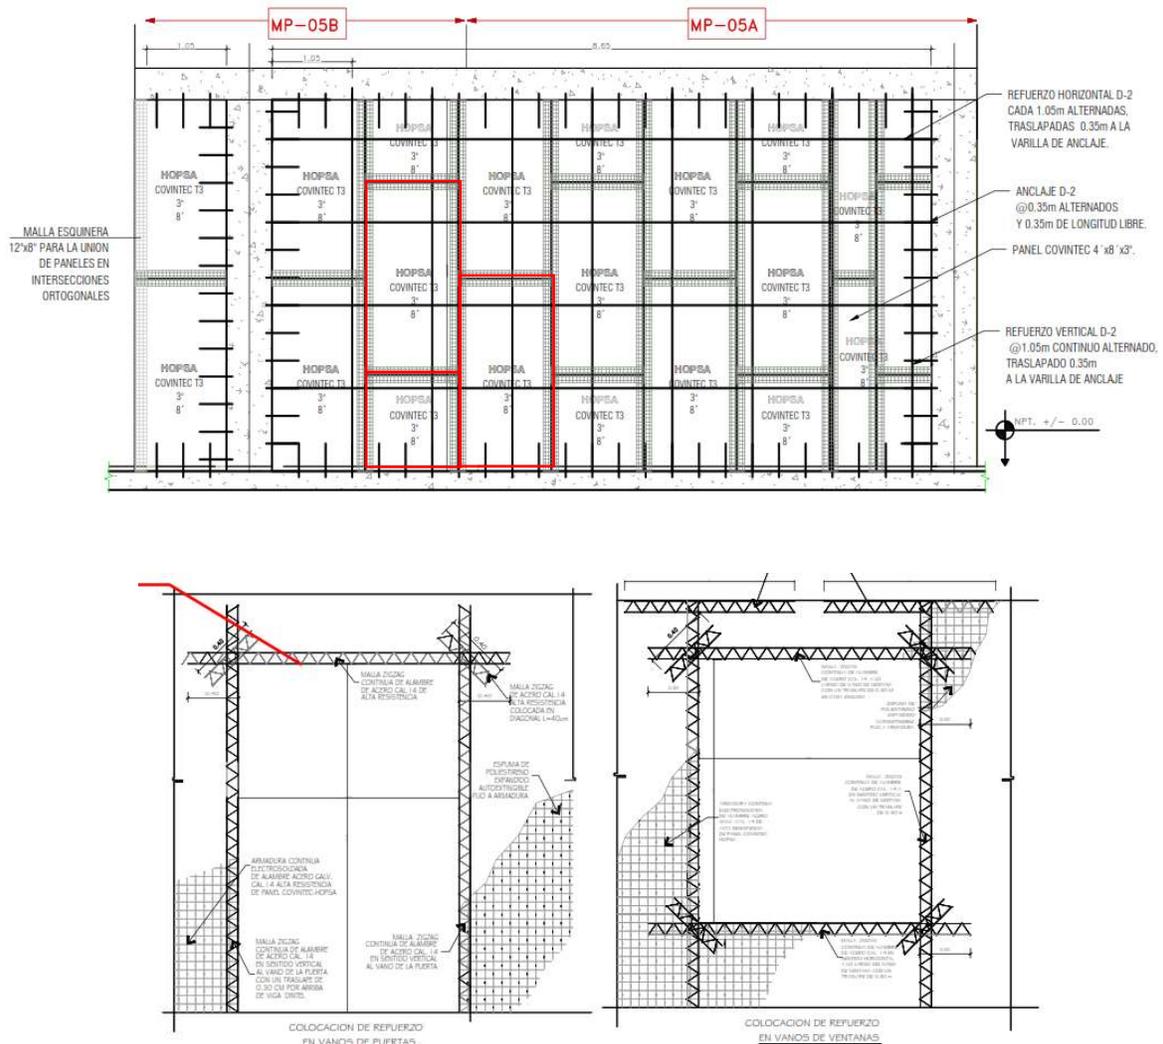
Panelizado y Detalle de accesorio Covintec en boquetes
